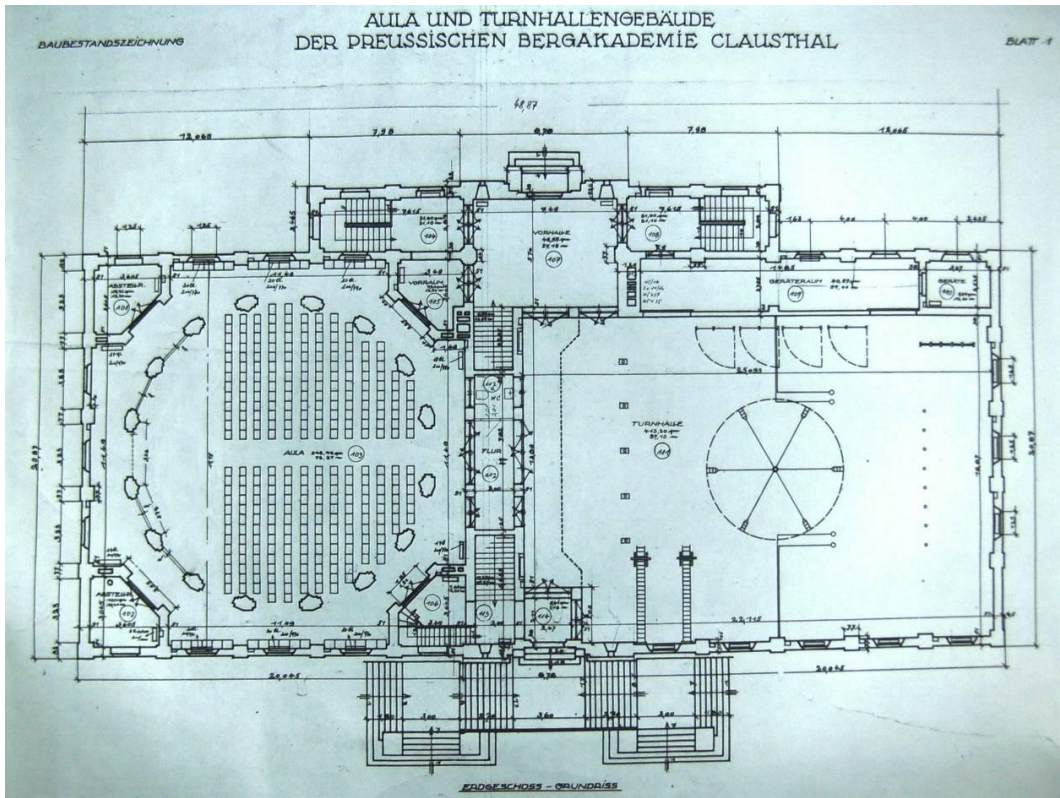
Aula und Turnhalle. Grundriss des Erdgeschosses.
